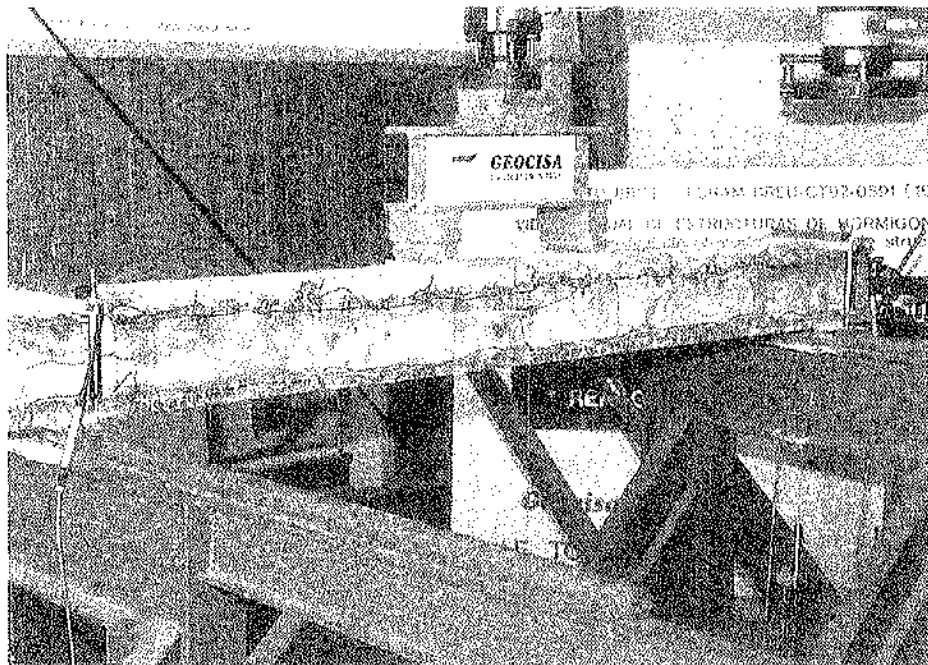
Vista del ensayo de carga de una viga con armaduras corroídas.
